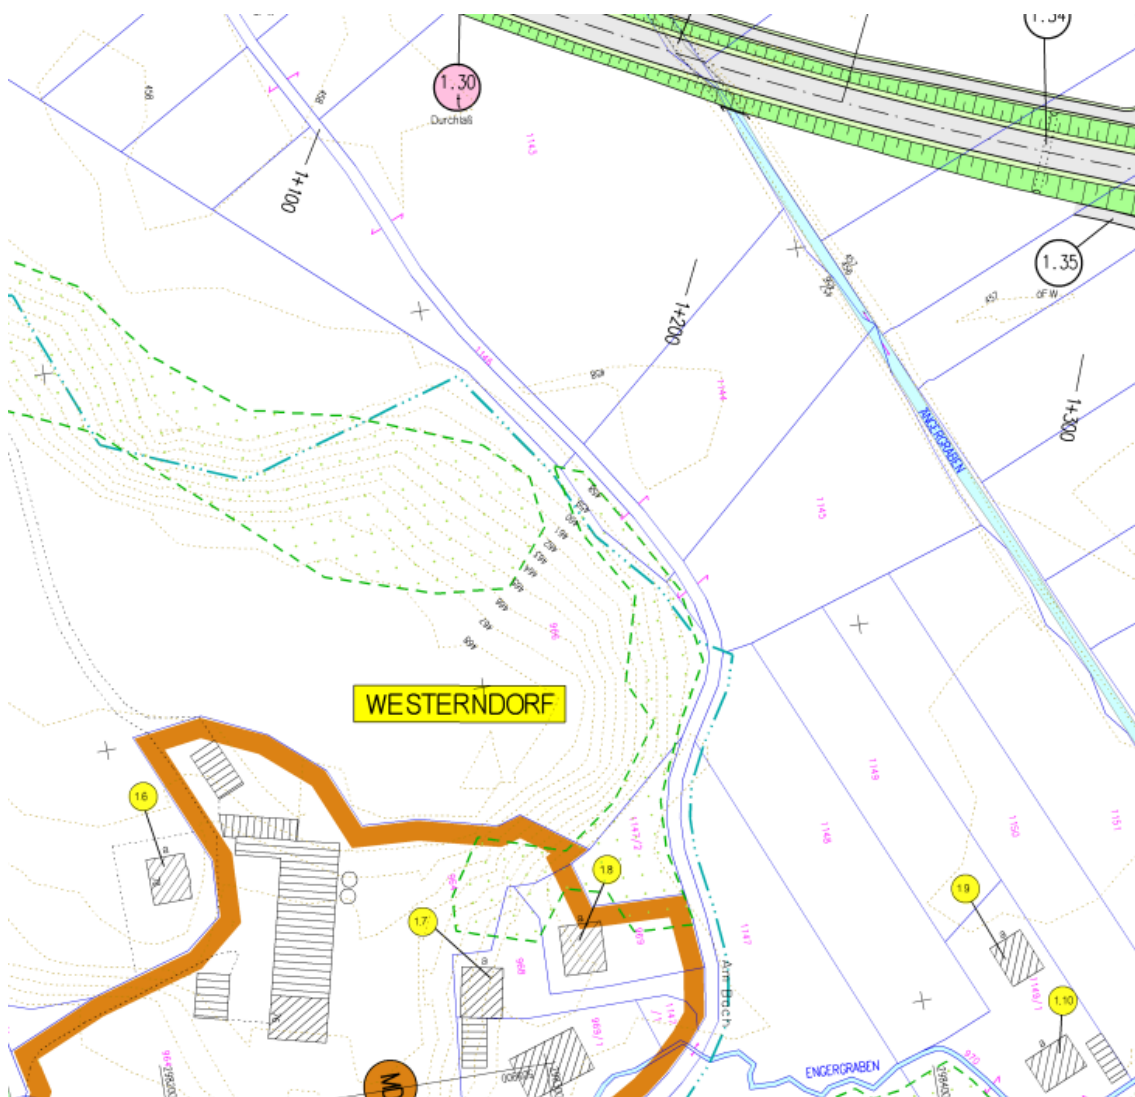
Tektur vom 20.12.2002 zur Planfeststellung vom 30.11.2000, Planfeststellung Westtangente Rosenheim Lageplan Bau-km 2+200, Straßenbauverwaltung Freistaat Bayern, Dorsch Consult GmbH.
